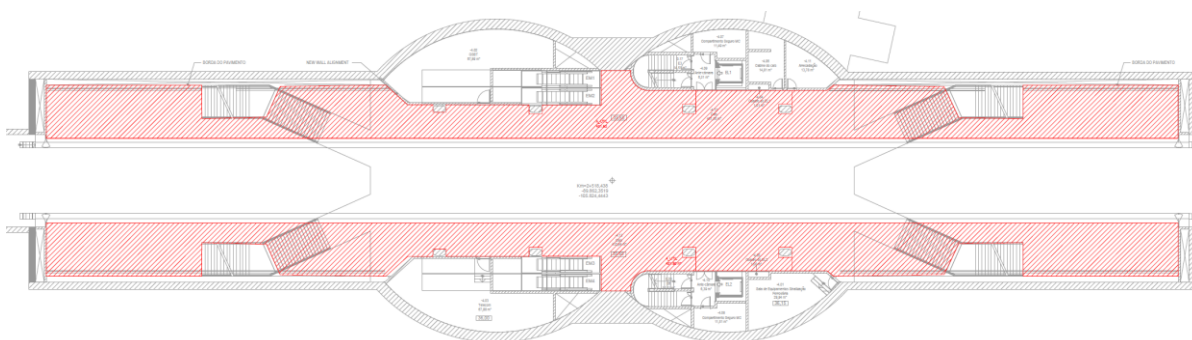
Estação Infante Santo, planta do Cais – determinação da área útil
